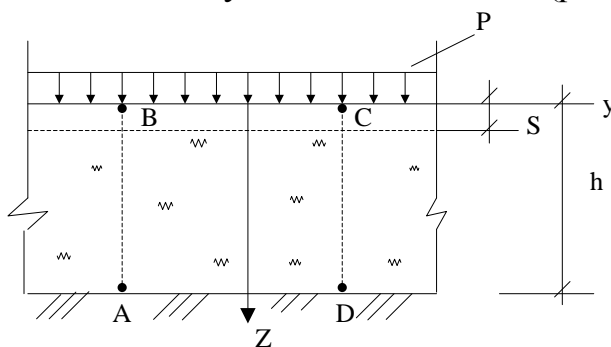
К расчету осадки слоя грунта при сплошной нагрузке
